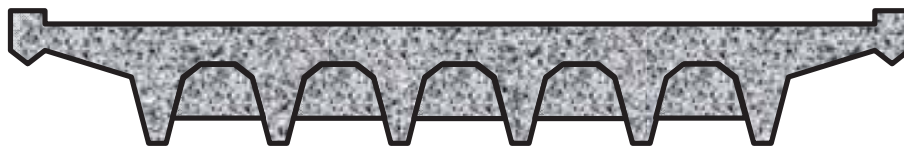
Esquema de la sección transversal tipo en losas macizas con nervadura
